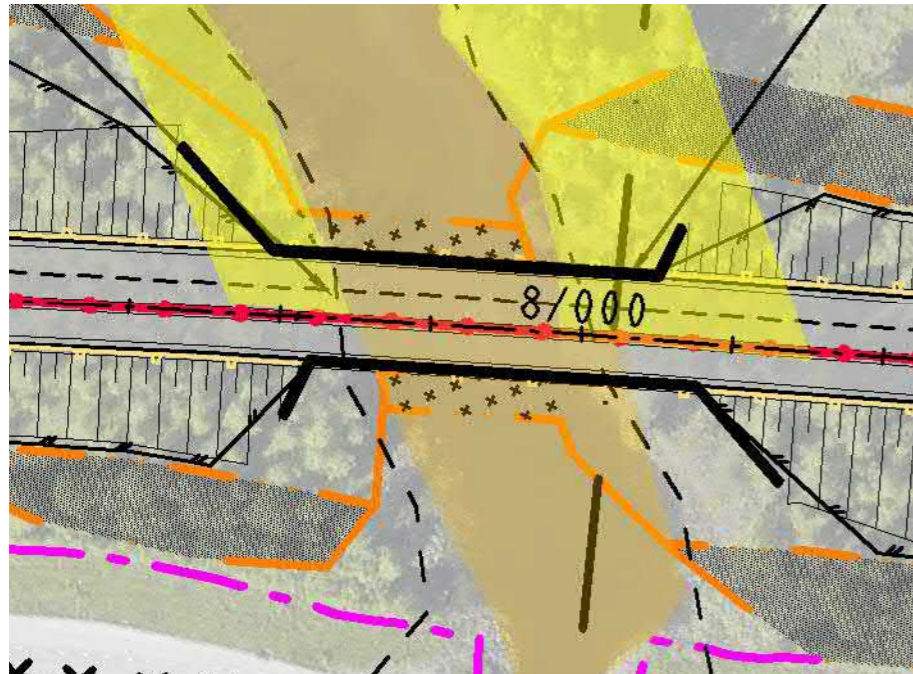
Planritning visande bro över Kälvån.
